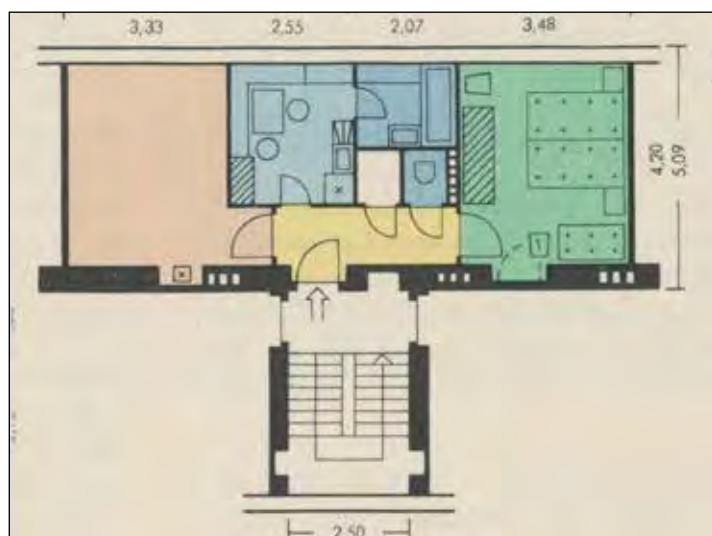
(links): bauzeitlicher Mustergrundriss einer 3-Zimmer-Wohnung (Quelle: Spengemann Grundrissatlas 1959)
